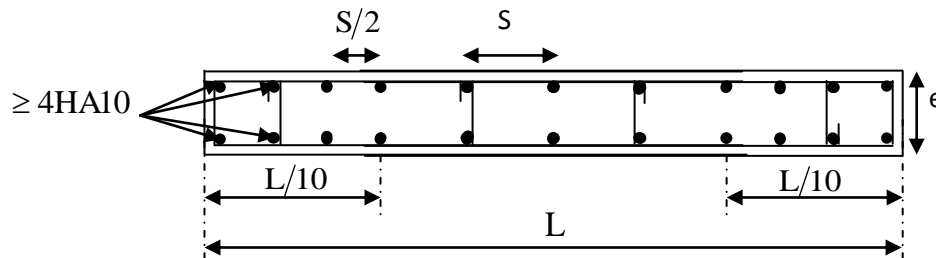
Disposition des armatures verticales dans les voiles.
